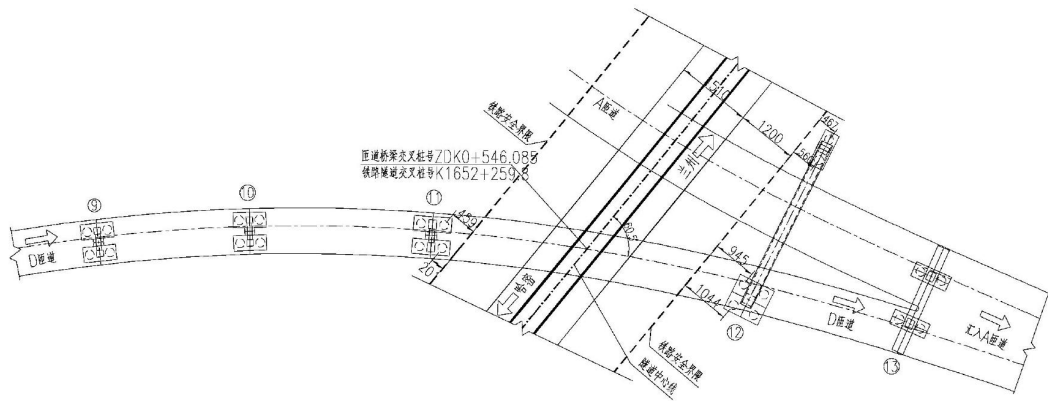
匝道 D 与铁路交叉处平面布置图
